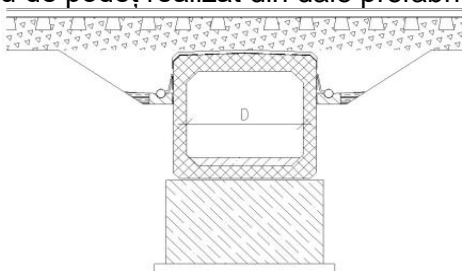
Exemplu de podeț realizat din cadre prefabricate din beton armat
